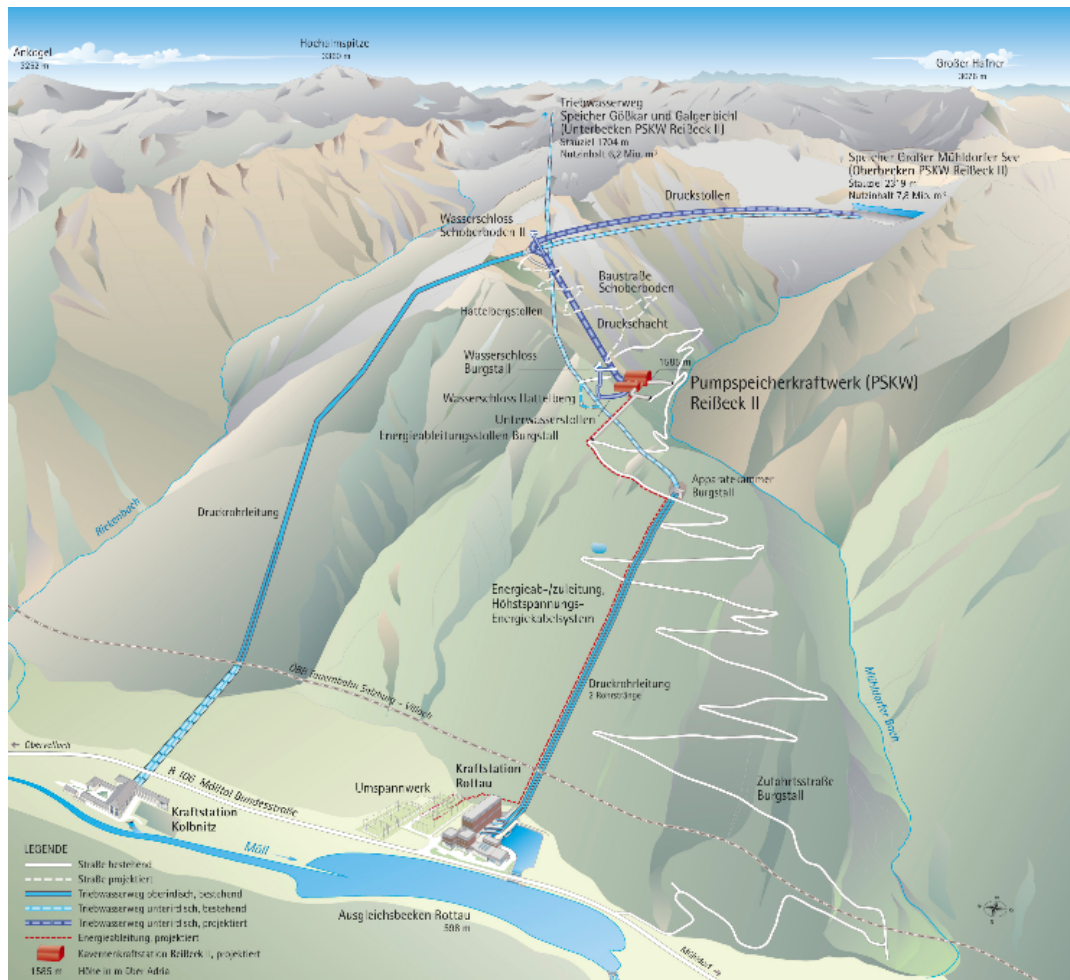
Lageplan Reißbeck II, Quelle: [3]
